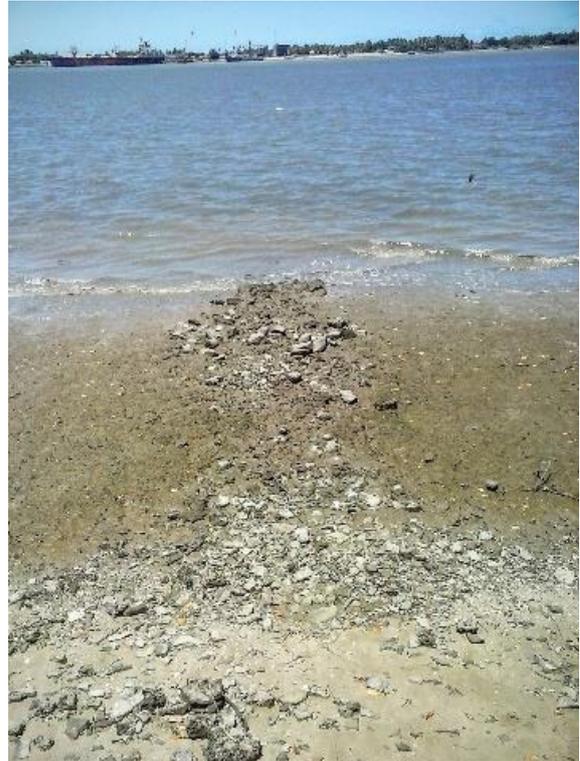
Estrutura 2 – fundação da ponte de embarque do hotel Brasil. Foto do autor, 2016.
